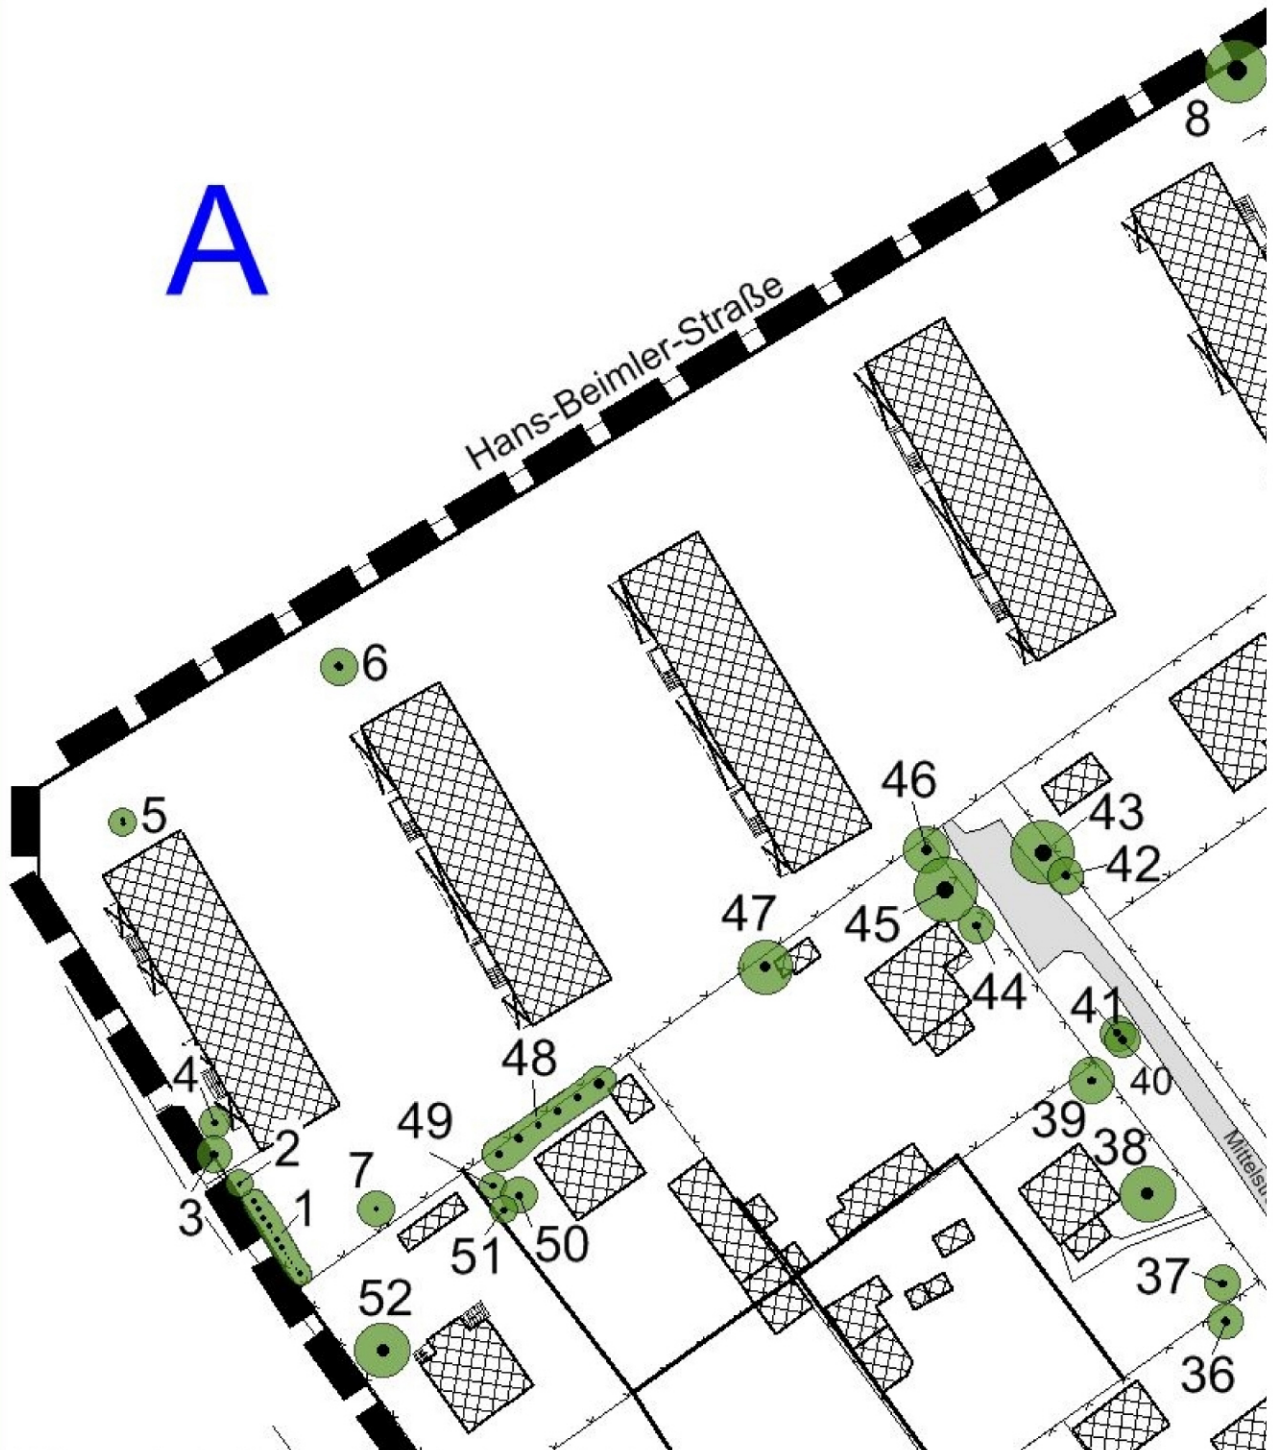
Bestand Bäume, Detailplan A, unmaßstäblich
